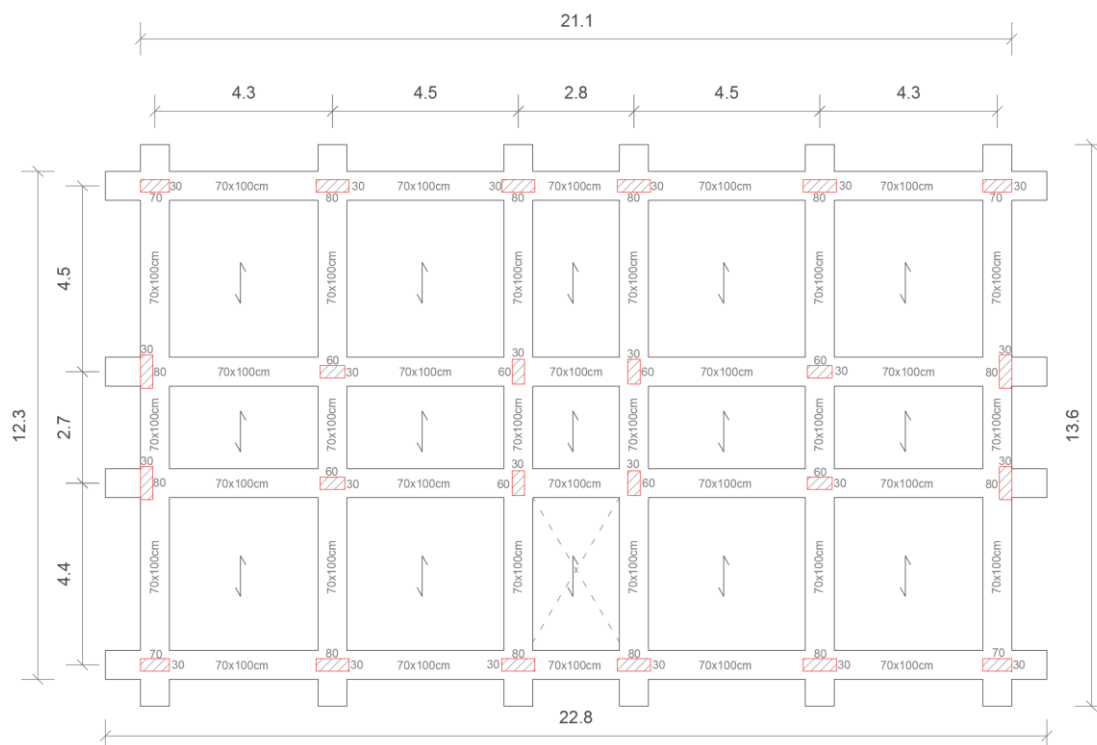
Carpenteria struttura in c.a. a due piani con graticcio di travi rovesce.
